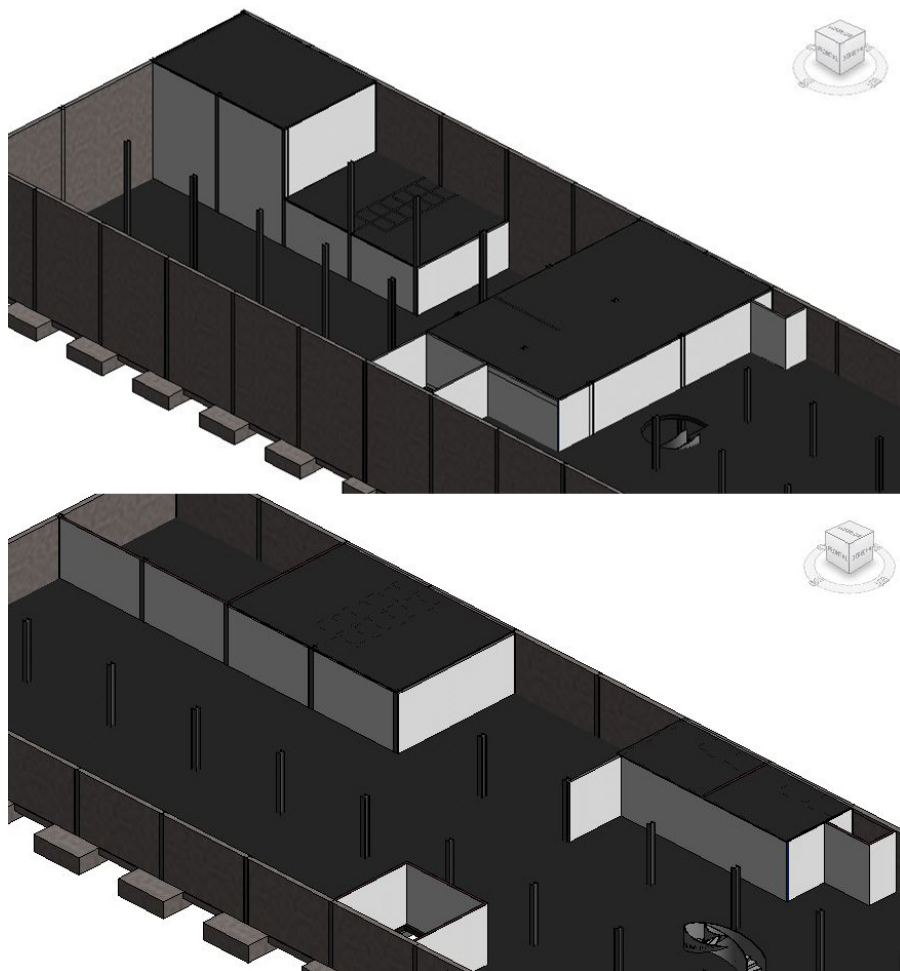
Detalle de techos de Planta Baja y Planta Alta
